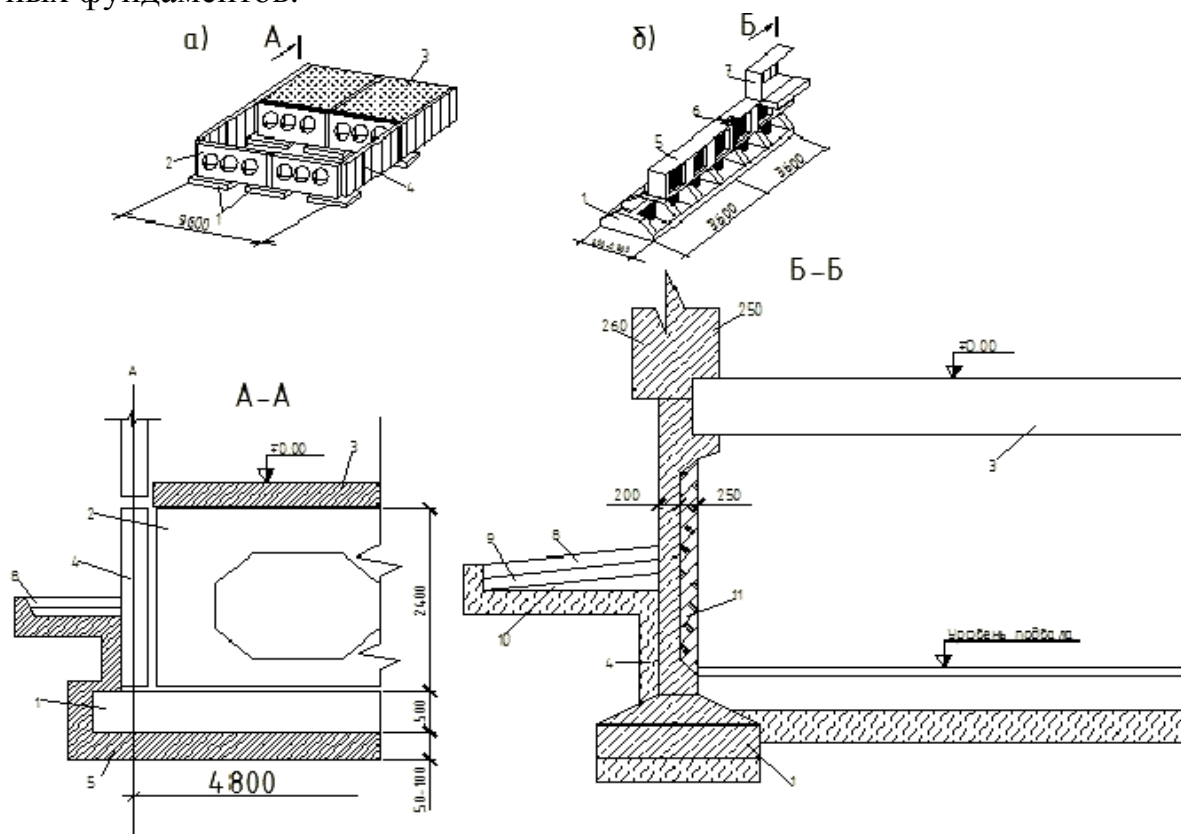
Конструкции облегченных ленточных фундаментов:
